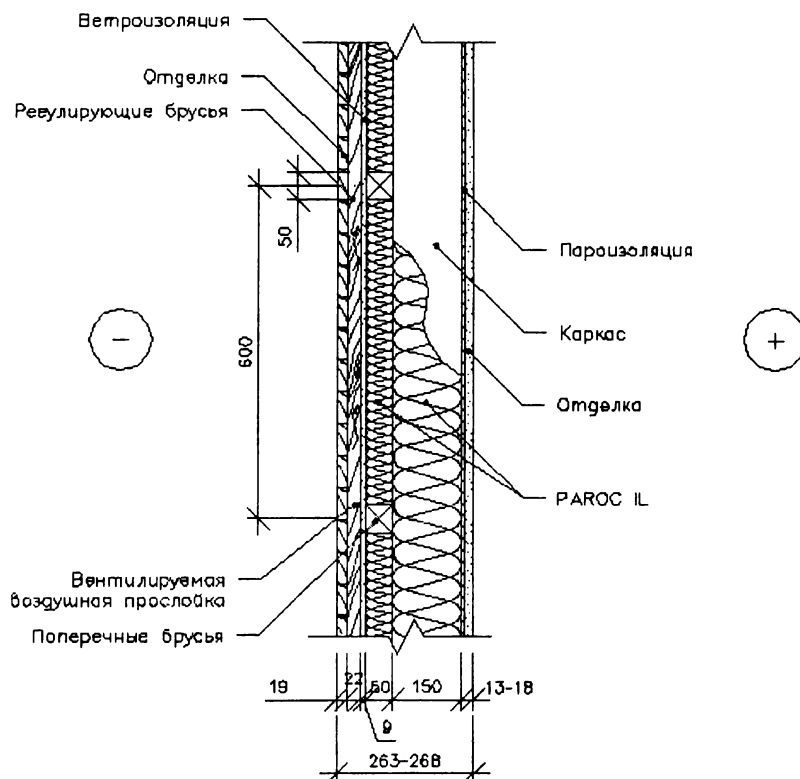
Деревянная каркасная стена с перекрывающимися слоями теплоизоляции
